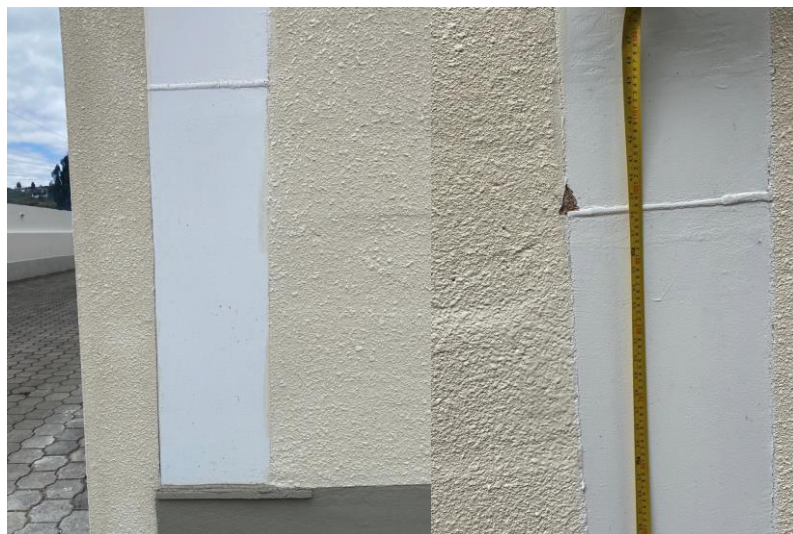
18: Detalle de la unión entre placas para la formación de columnas
